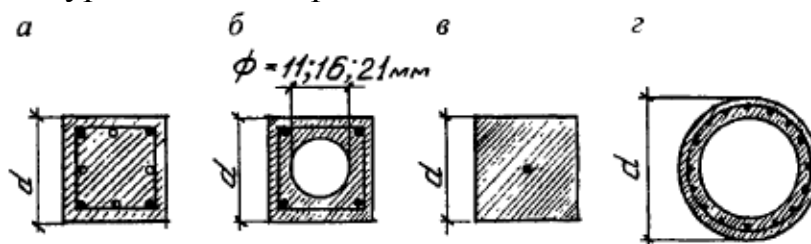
Конструкции сечений забивных железобетонных свай:
